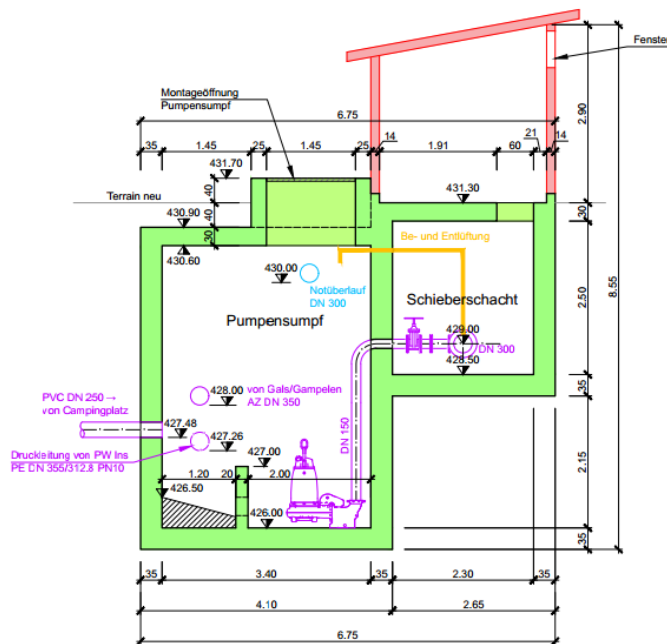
Coupe à travers la nouvelle station de pompage Rothaus
